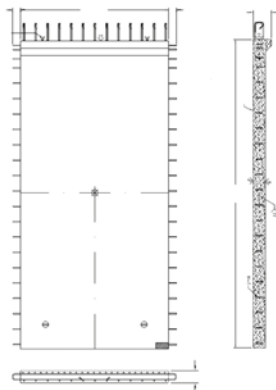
Sistema de paredes constituidas por paneles verticales de sección constante
